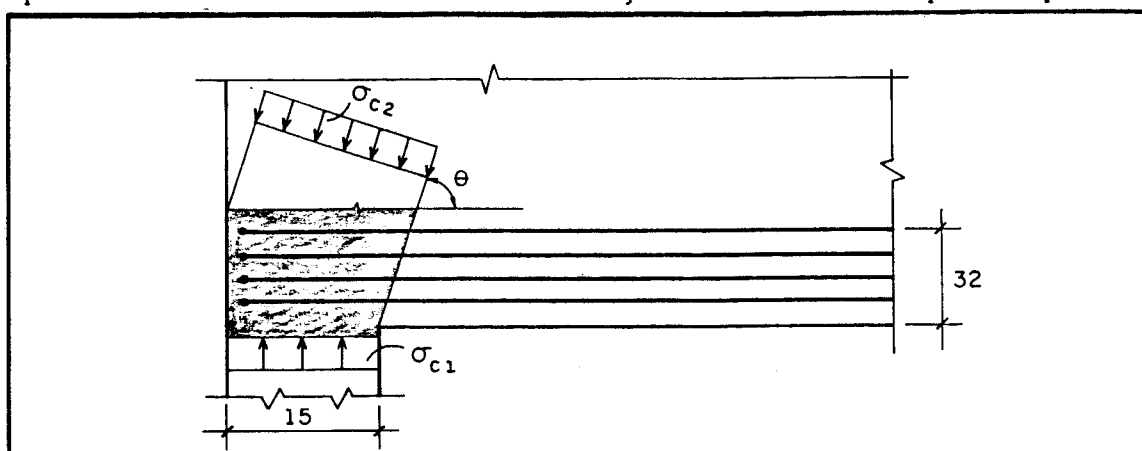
Detalhe da distribuição da armadura principal e do nó do apoio esquerdo.
